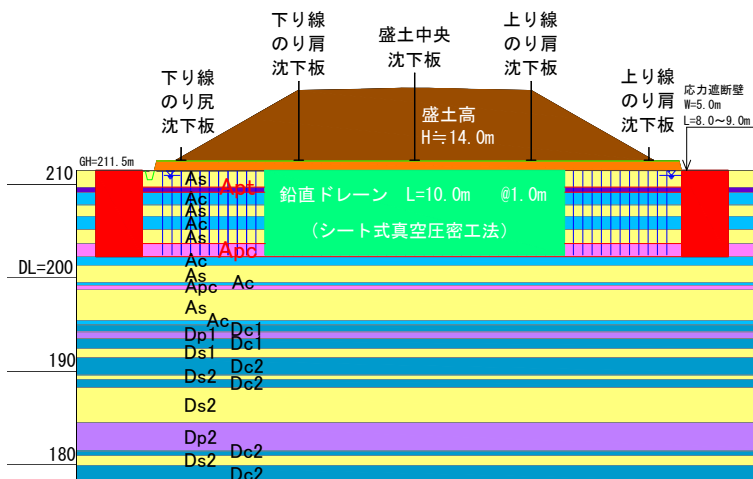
土層断面図と真空圧密工法および載荷盛土断面図
